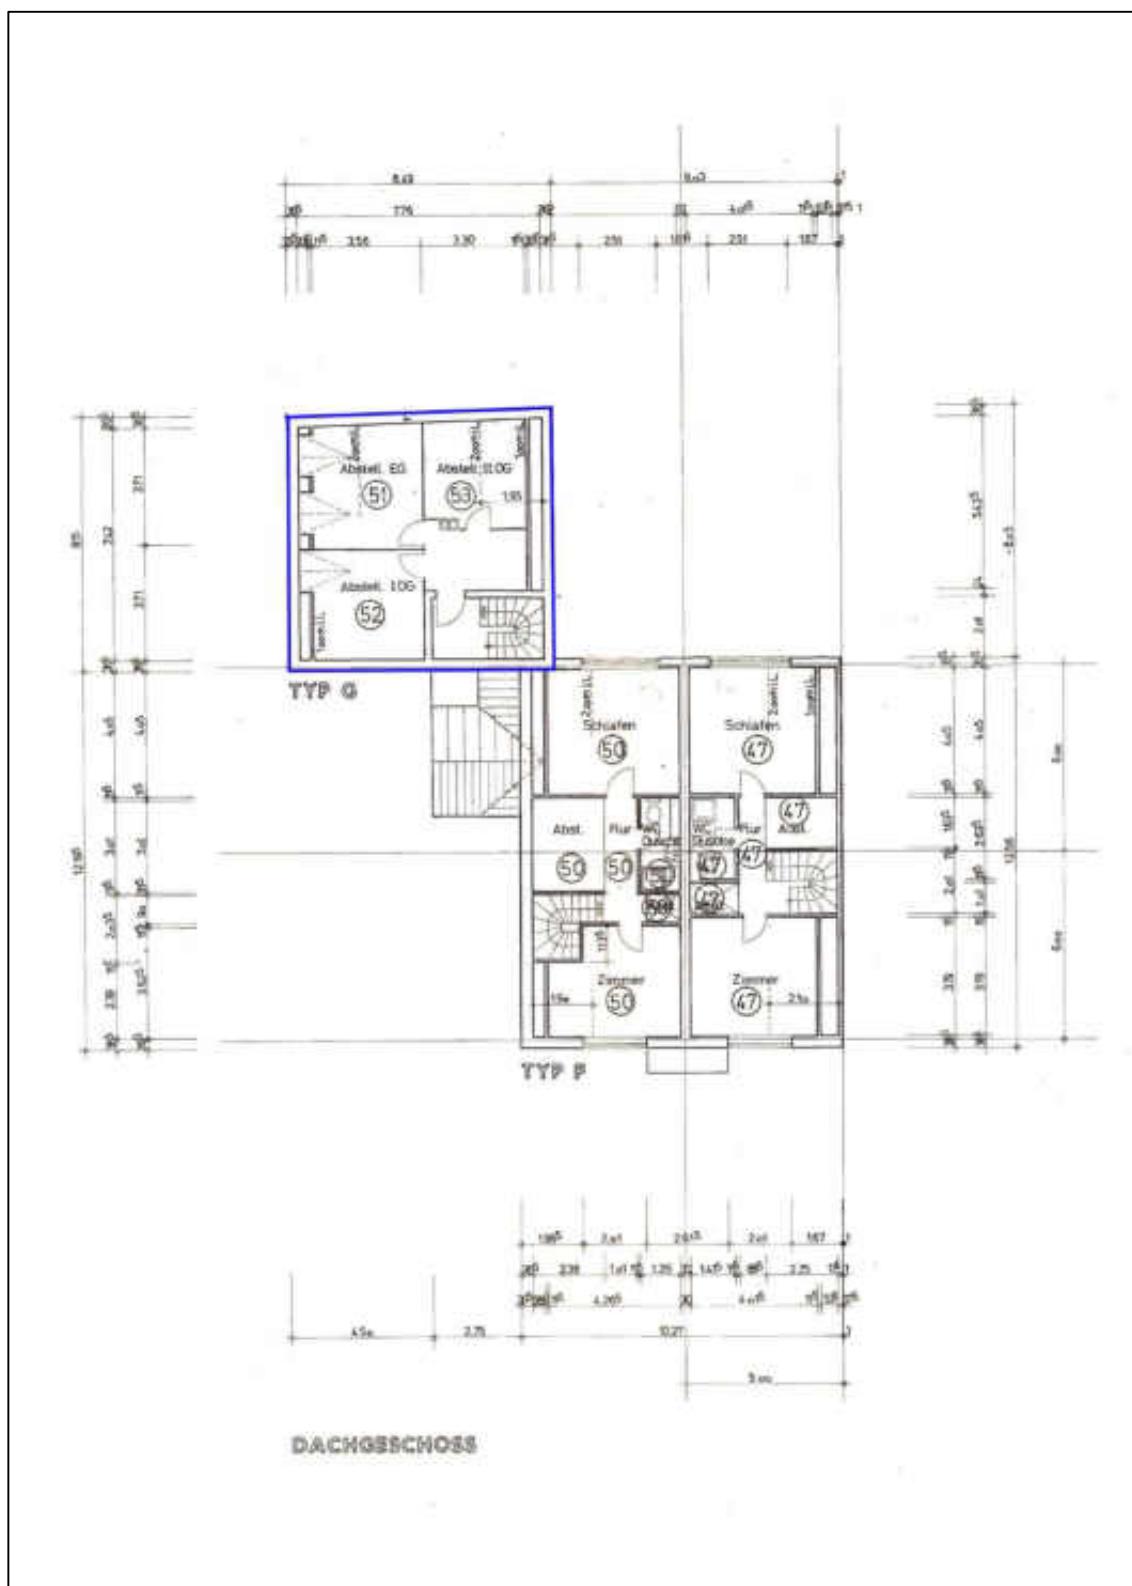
Grundriss vom Dachgeschoß vom Gebäudetyp G
